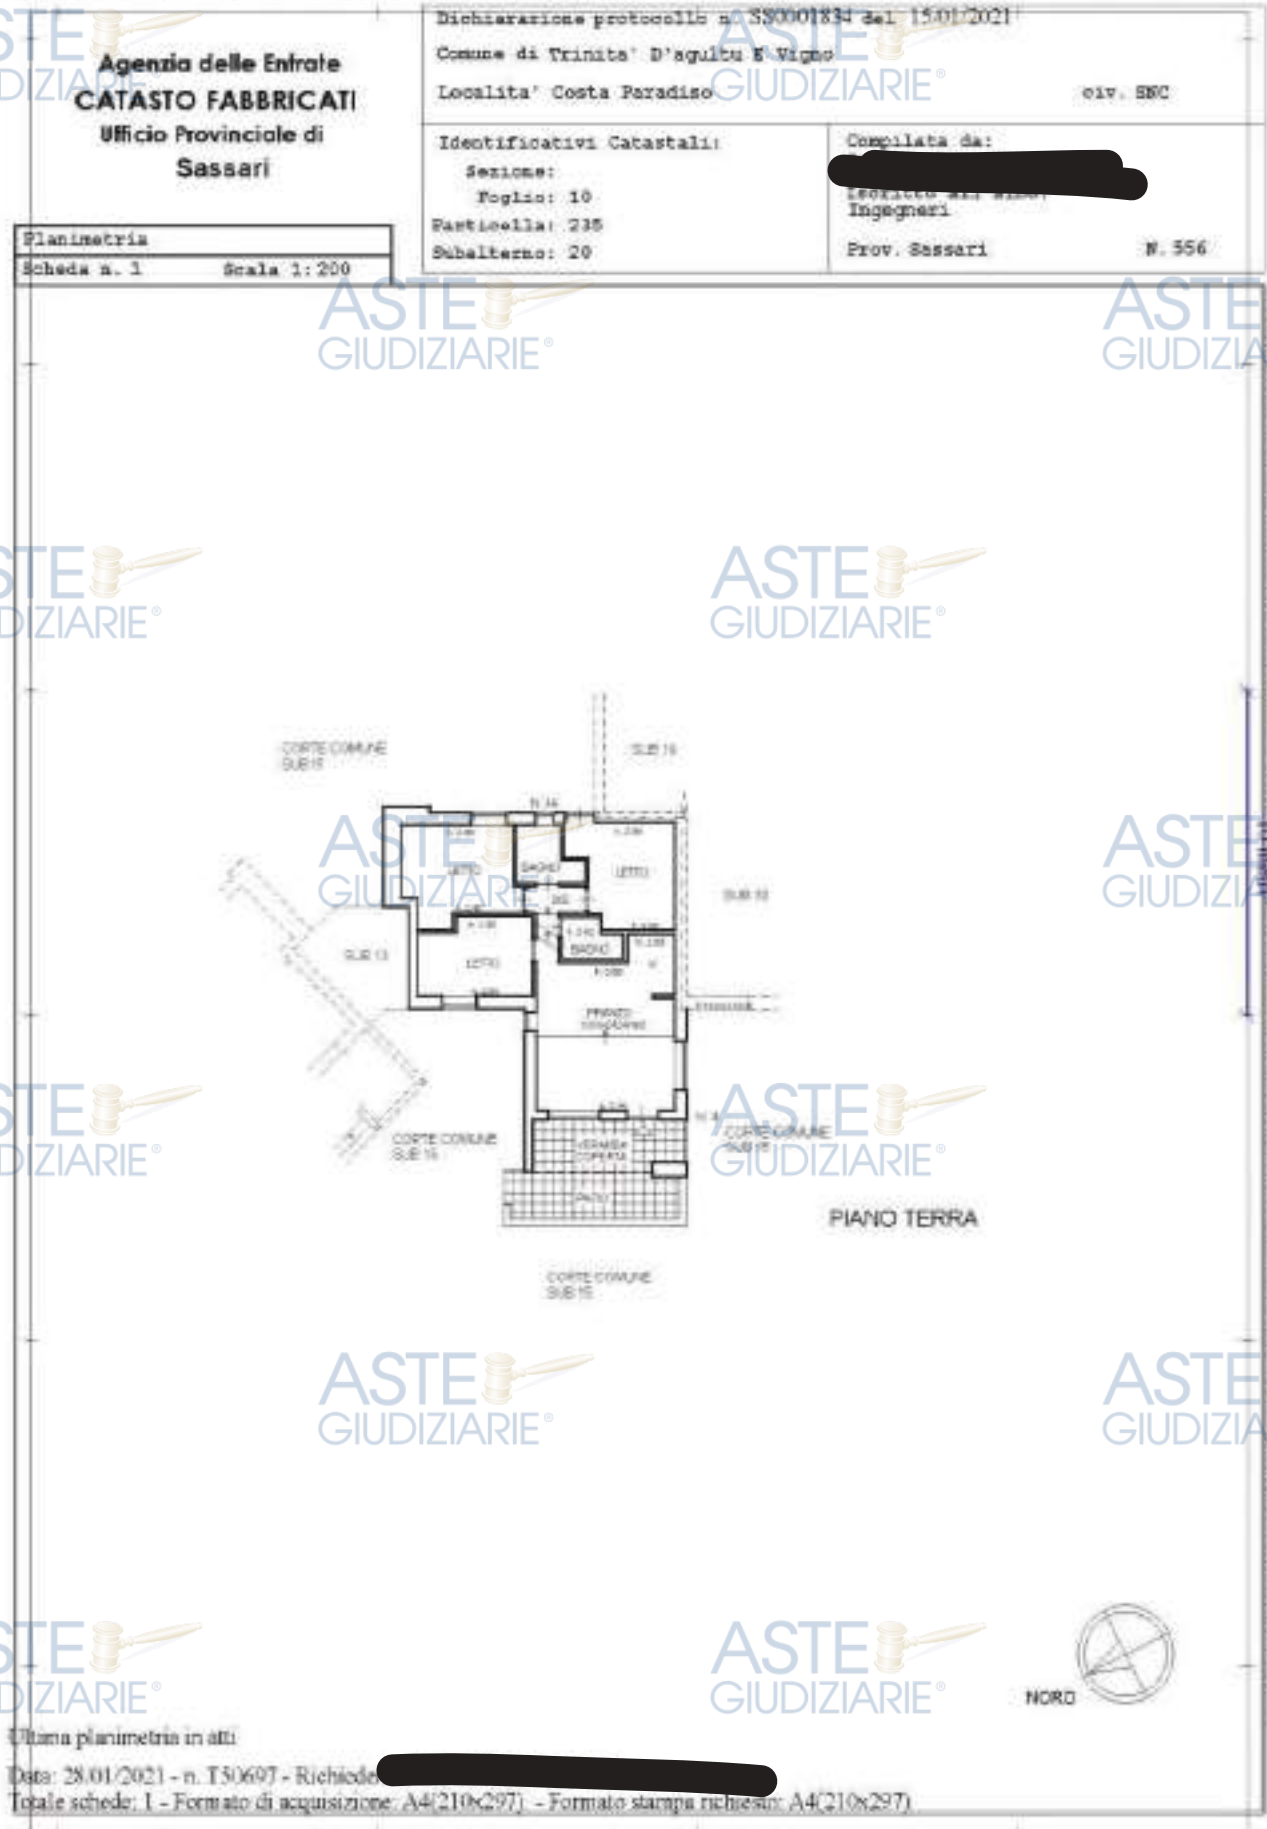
Visura planimetrica catastale Fig. 10 Part. 235 Sub 20 (ex Fig. 10 Part. 235 Sub 9)
